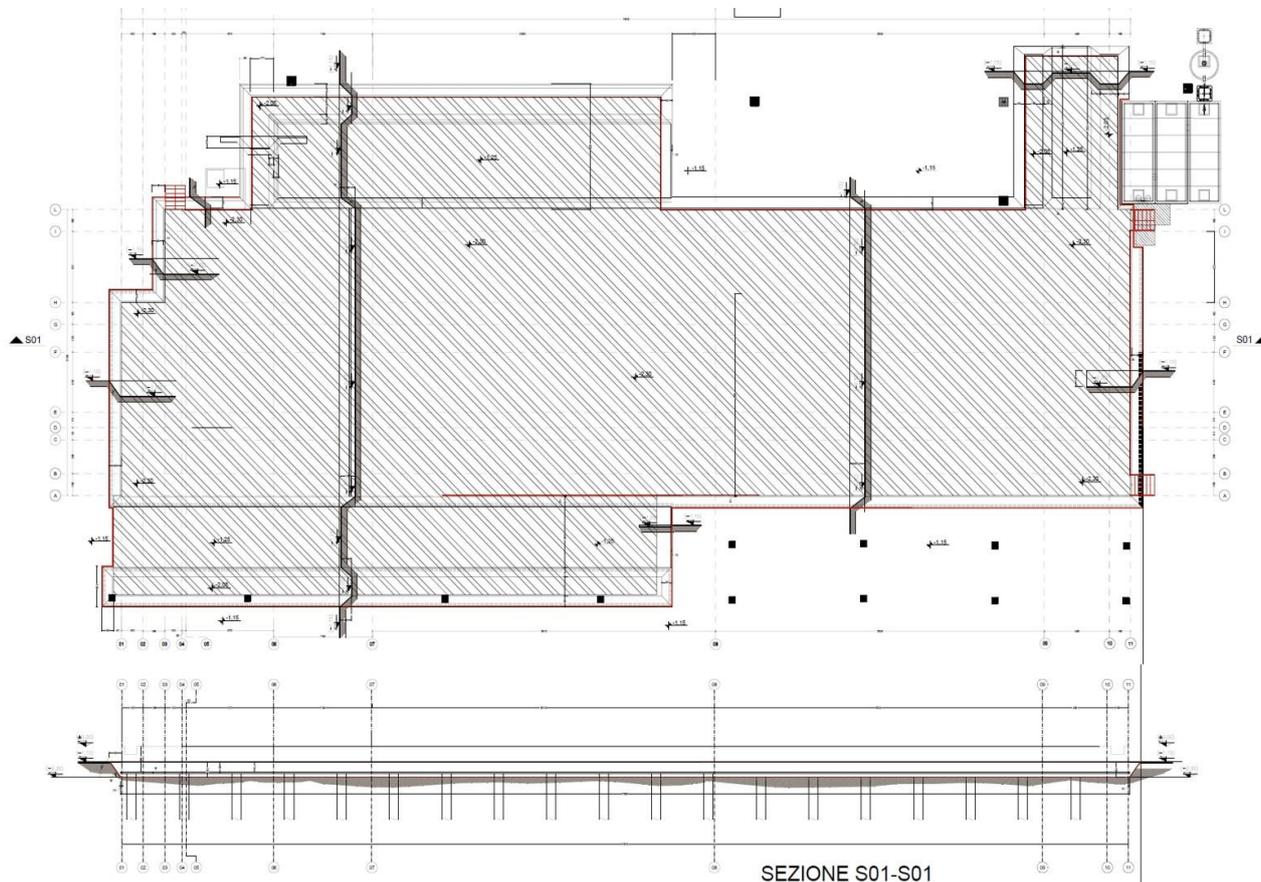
Planimetria degli scavi in area A- edificio Deposito (tratto da GRDT01437_rev00)
